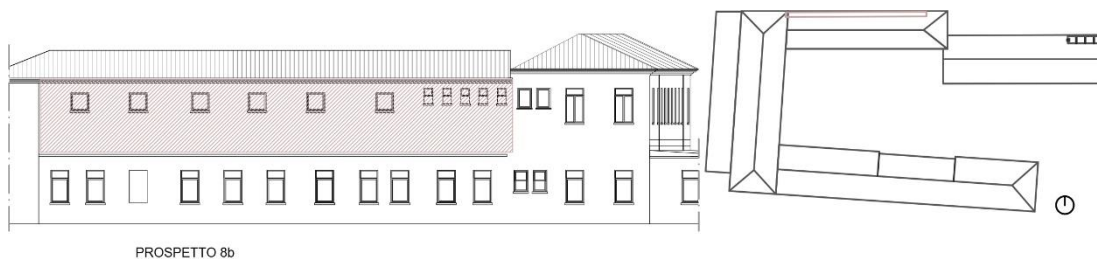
Individuazione del macroelemento in prospetto e pianta
